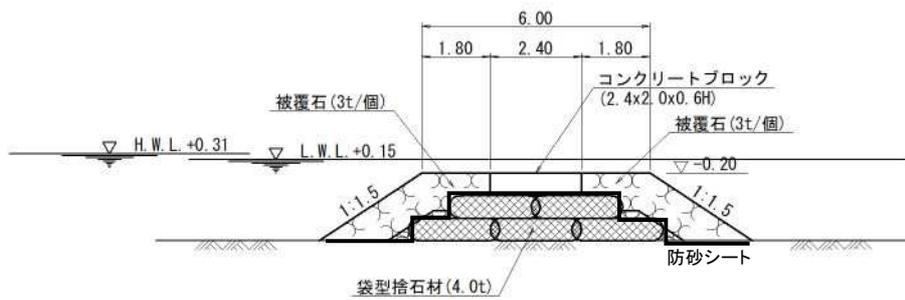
(6) 潜堤本體(完成時)の標準断面図
